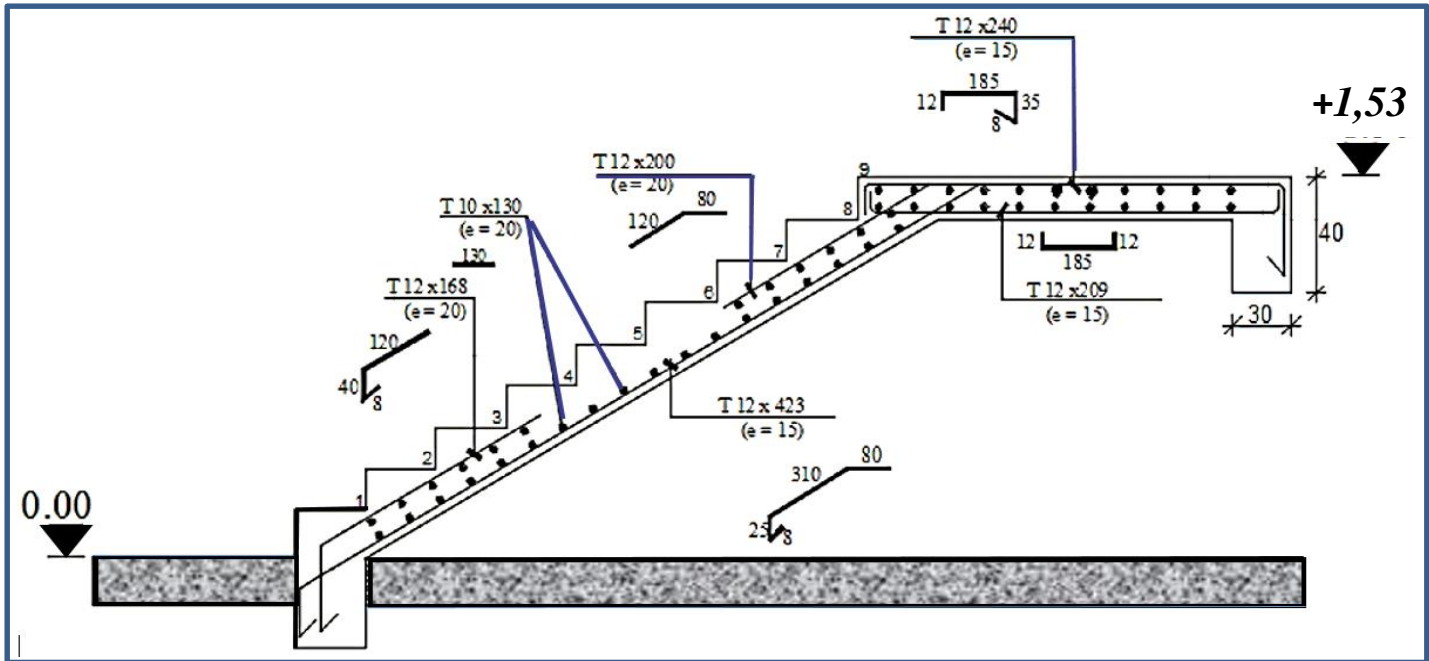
Dessin de ferrailage de l'escalier à paillasse porteuse.
